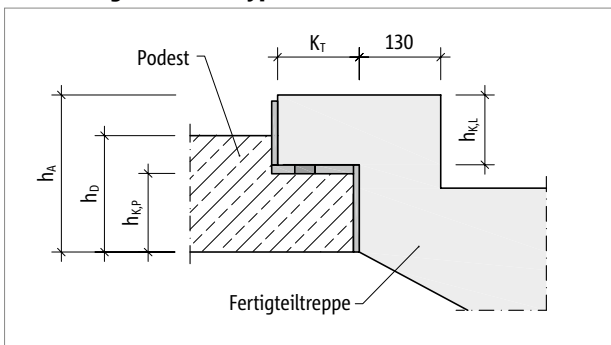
Schöck Tronsole® Typ BZ: Bemessung
